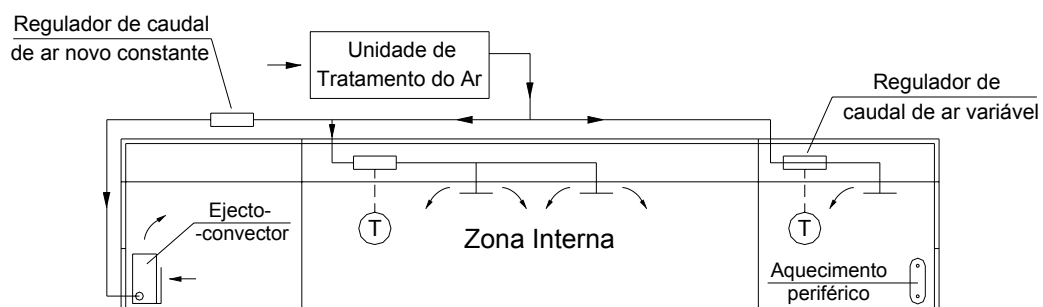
Sistema a VAV aplicado conjuntamente com outros.
